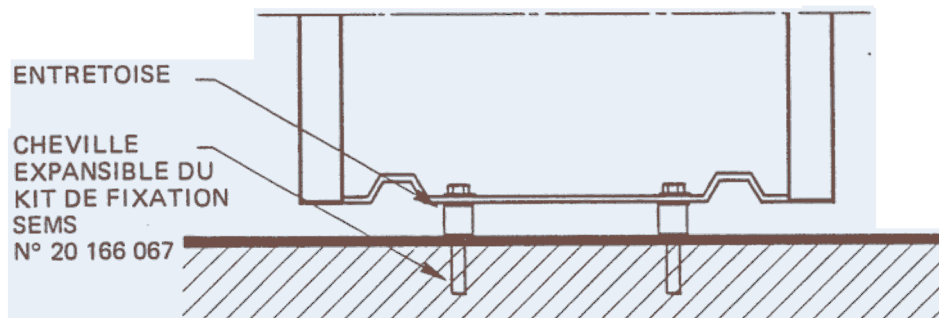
FIXATION SUR ENTRETOISES
